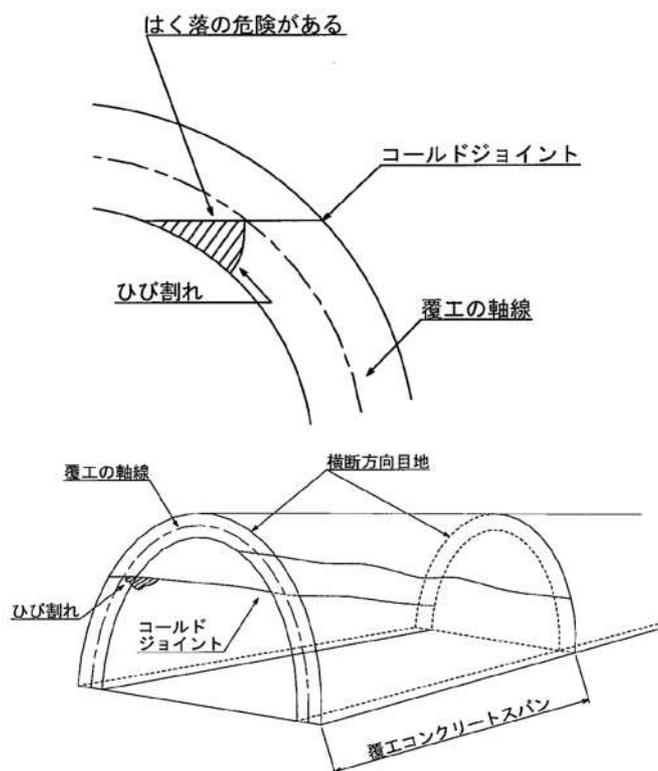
コールドジョイント付近に発生するひび割れの例¹⁾
